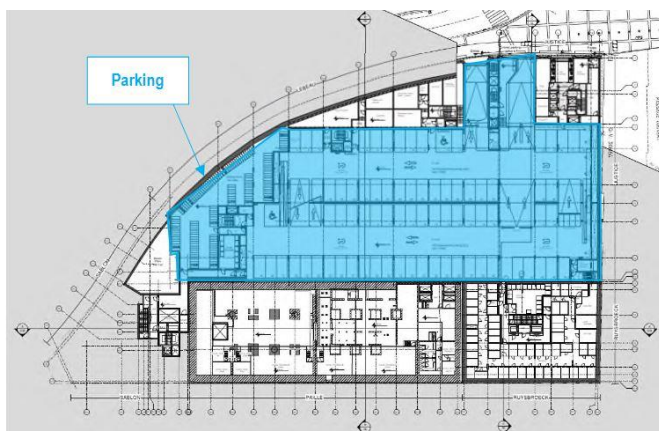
Implantation du parking en situation projetée : niveau d'accès - niveau 0 du bâtiment Justice (ARIES sur fond de plan Assar Architects, MLA et KSA, 2019)
